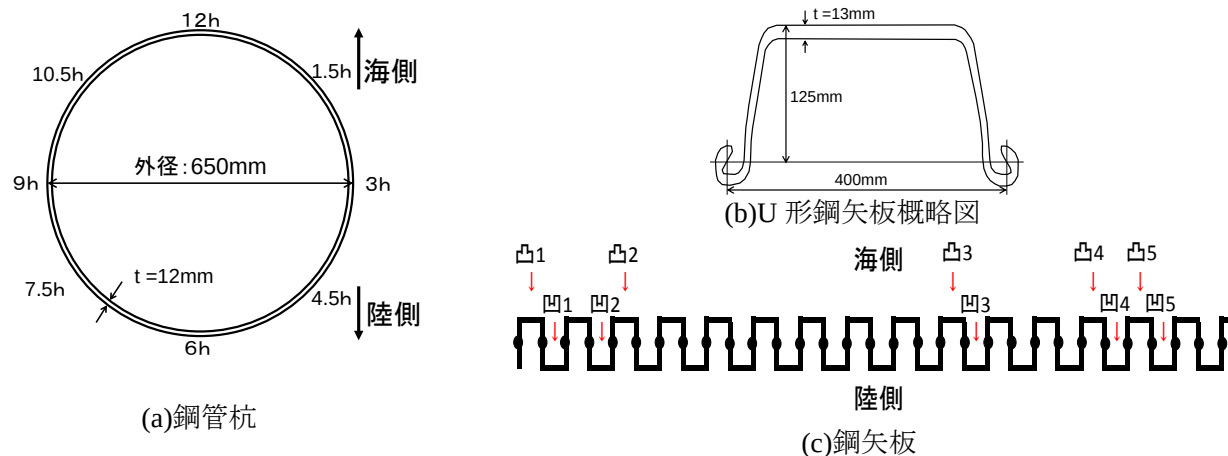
鋼管杭と鋼矢板の水平面内板厚測定位置
